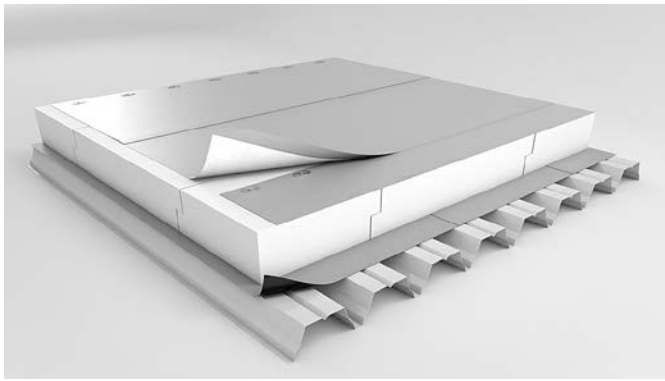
Typischer Dachaufbau eines Industrie-Leichtdaches
